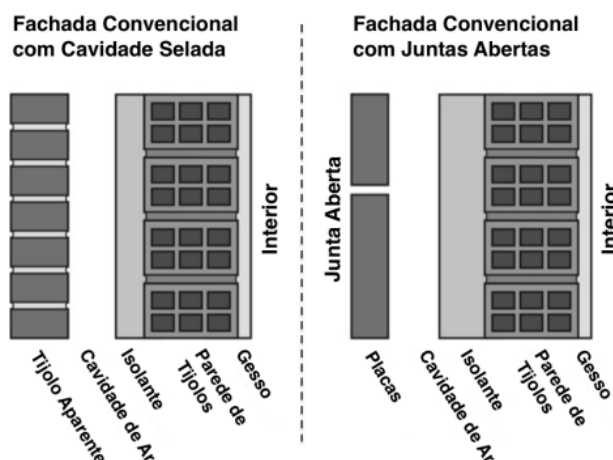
Diferença na transferência de calor - fachada cortina e fachada ventilada
